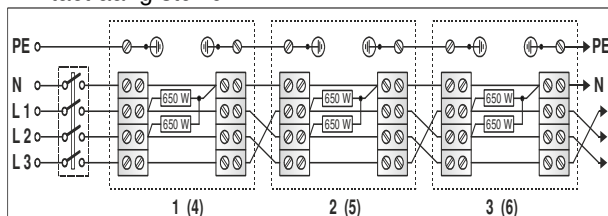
Voorbeeld voor 3 aangestuurde infraroodstralers. Spanningsvoorziening 3/N/PE 400V~.
